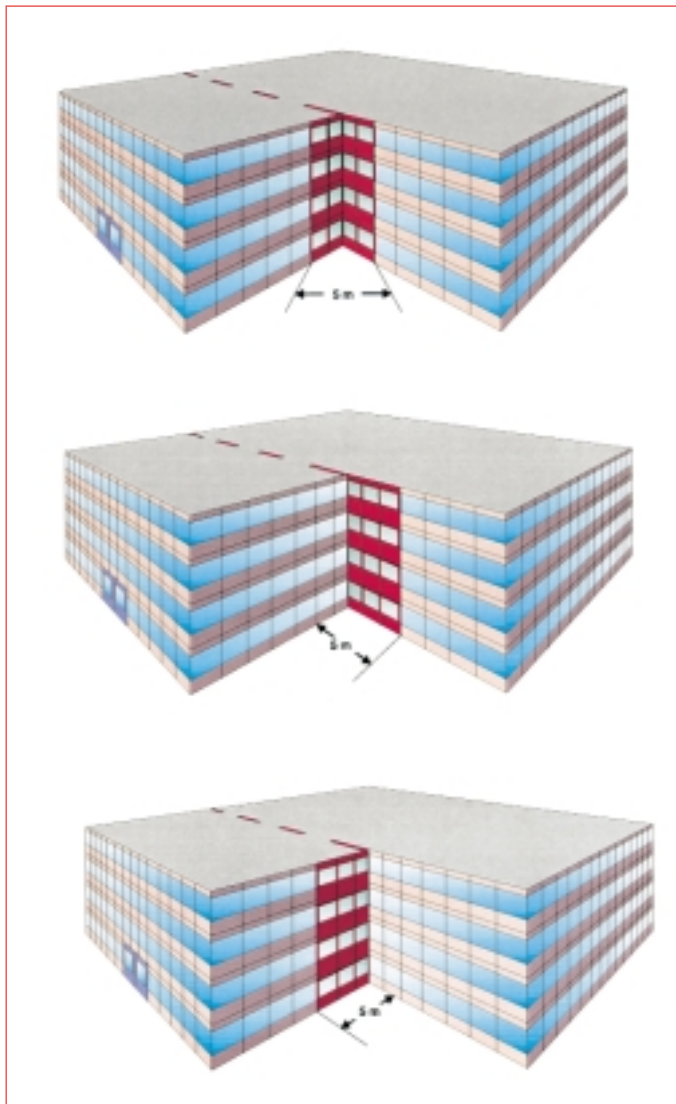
Erhöhte bauliche Brandschutzanforderungen bei Variante Stufenhaus
